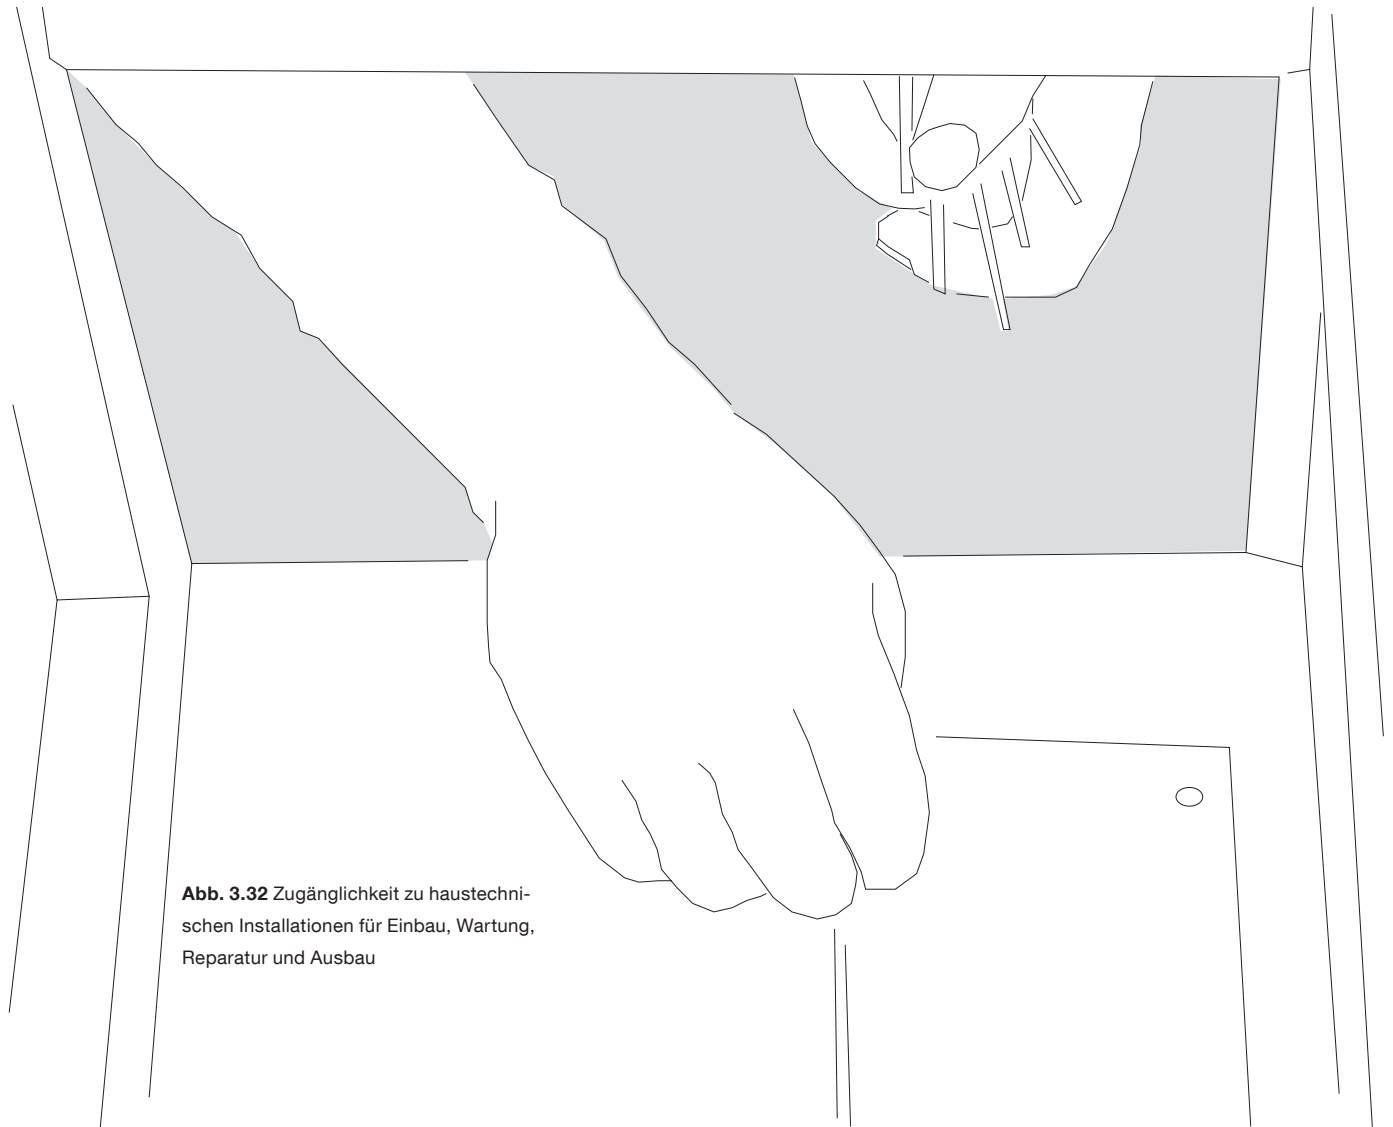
Zugänglichkeit zu haustechnischen Installationen für Einbau, Wartung, Reparatur und Ausbau
